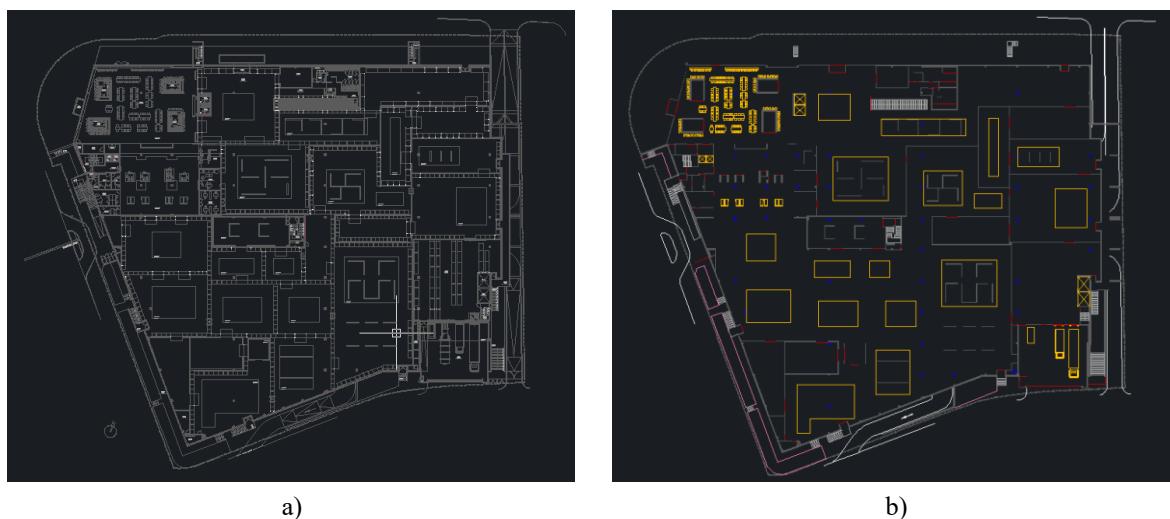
Preparação das plantas do edifício: a) Planta original do edifício; b) Planta com elementos de desenho para representação da planta do edifício isolados¹⁹
